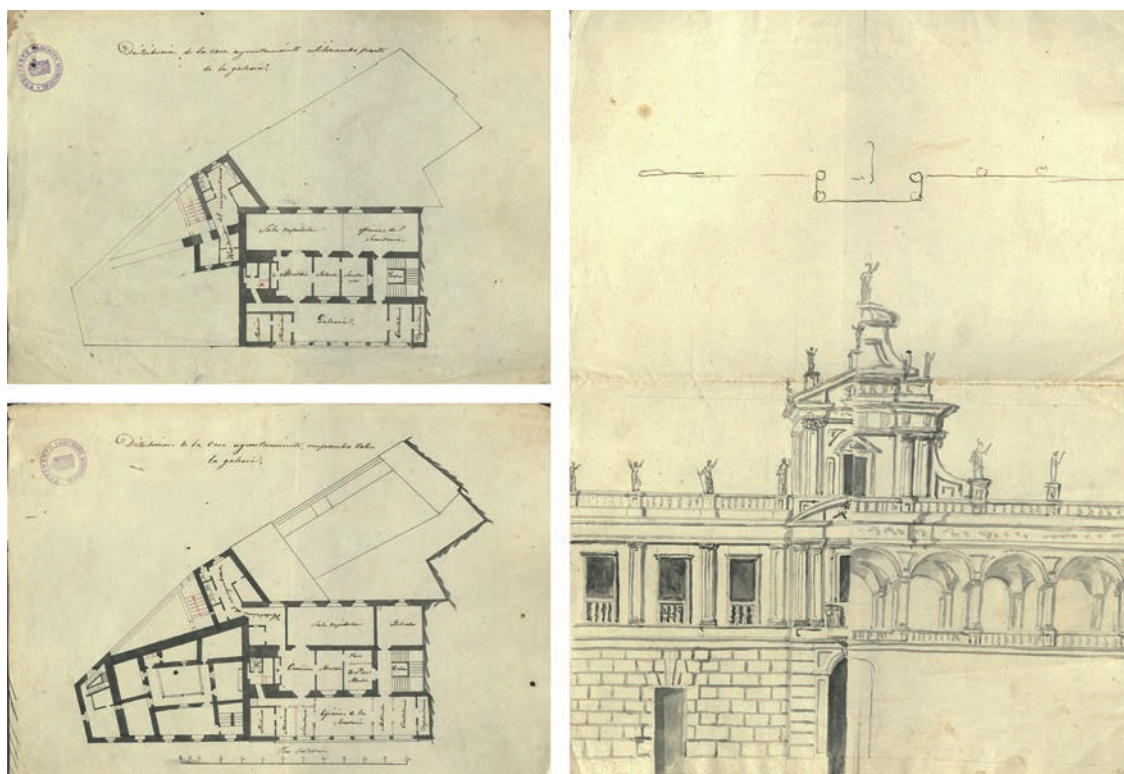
Planos de Carlos Mancha de 1862, dos versiones de la planta primera y alzado (AMC, Expediente CH02150_00001, Carlos Mancha, Planos del 12 de mayo de 1862).
